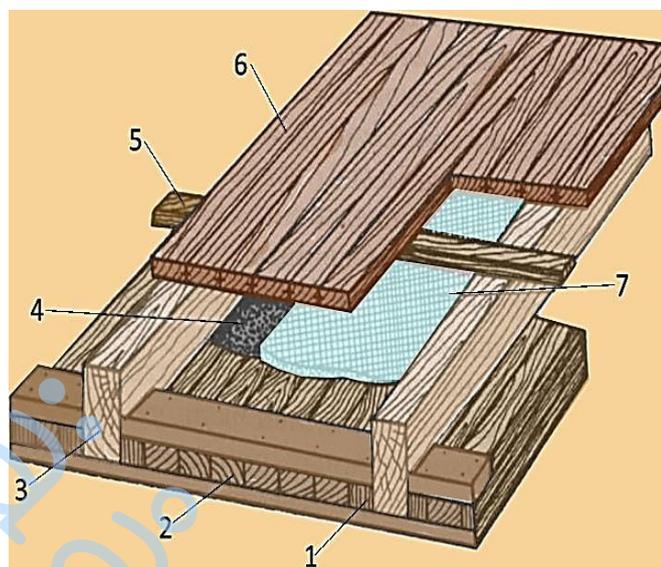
Принципиальная схема устройства междуэтажного перекрытия по деревянным балкам:
